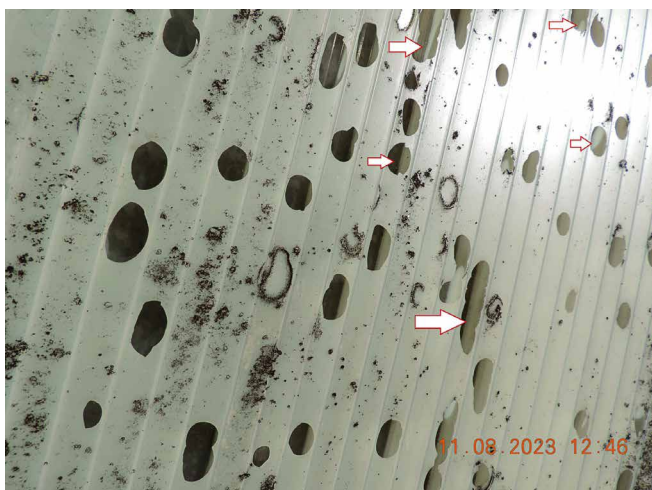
Detailansicht der Stegkammerbeschädigungen (© ILS-Bau-Consulting)
